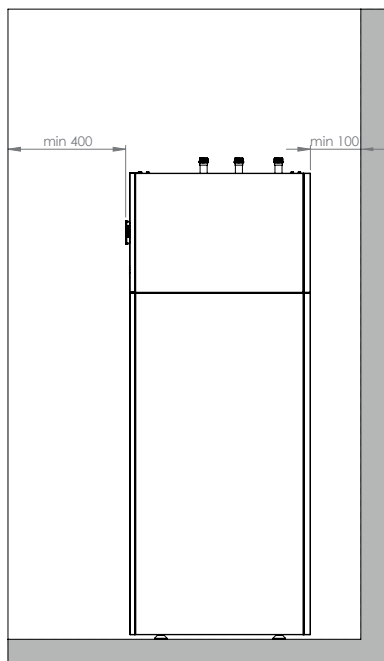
Montageabstände für das Onebox Hydraulikmodul
